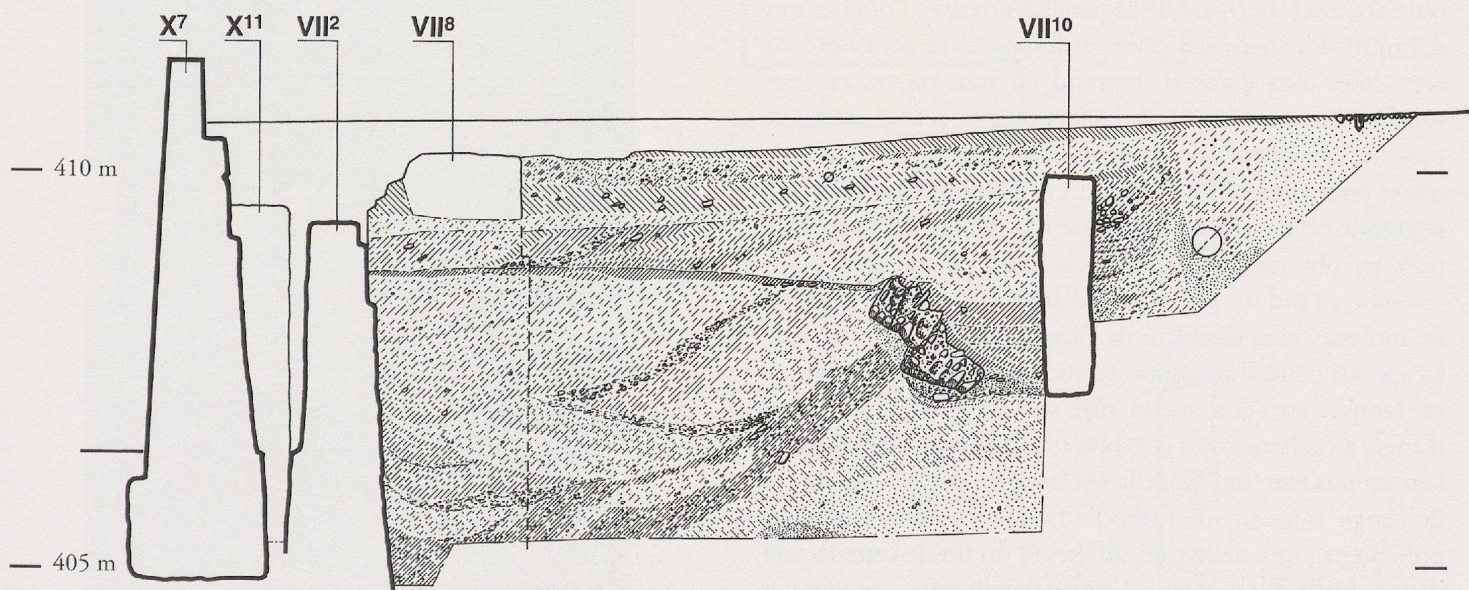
Coupe au travers de la terrasse ouest, avec les murs de terrasse successifs (éch. 1:100; légende en fig. 16).
